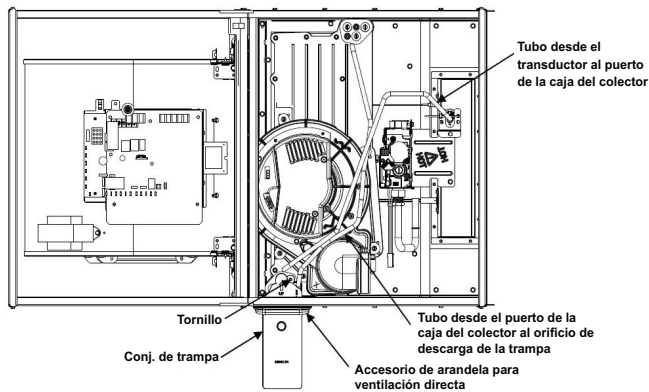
Horizontal derecha: Auxiliar del ensamblaje de la trampa
